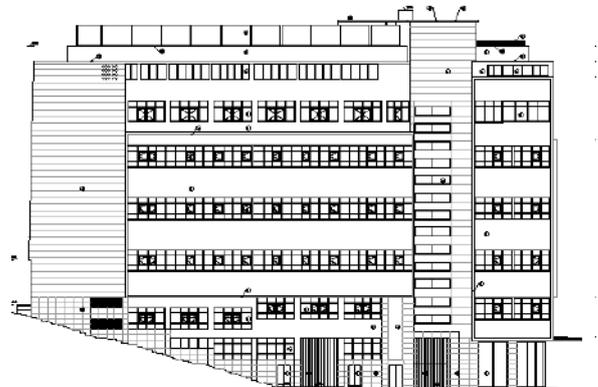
“Edifício Conde Barão” Projeto – Alçado poente (Fonte: Gesturbe, proc. 782/EDI/2016)
